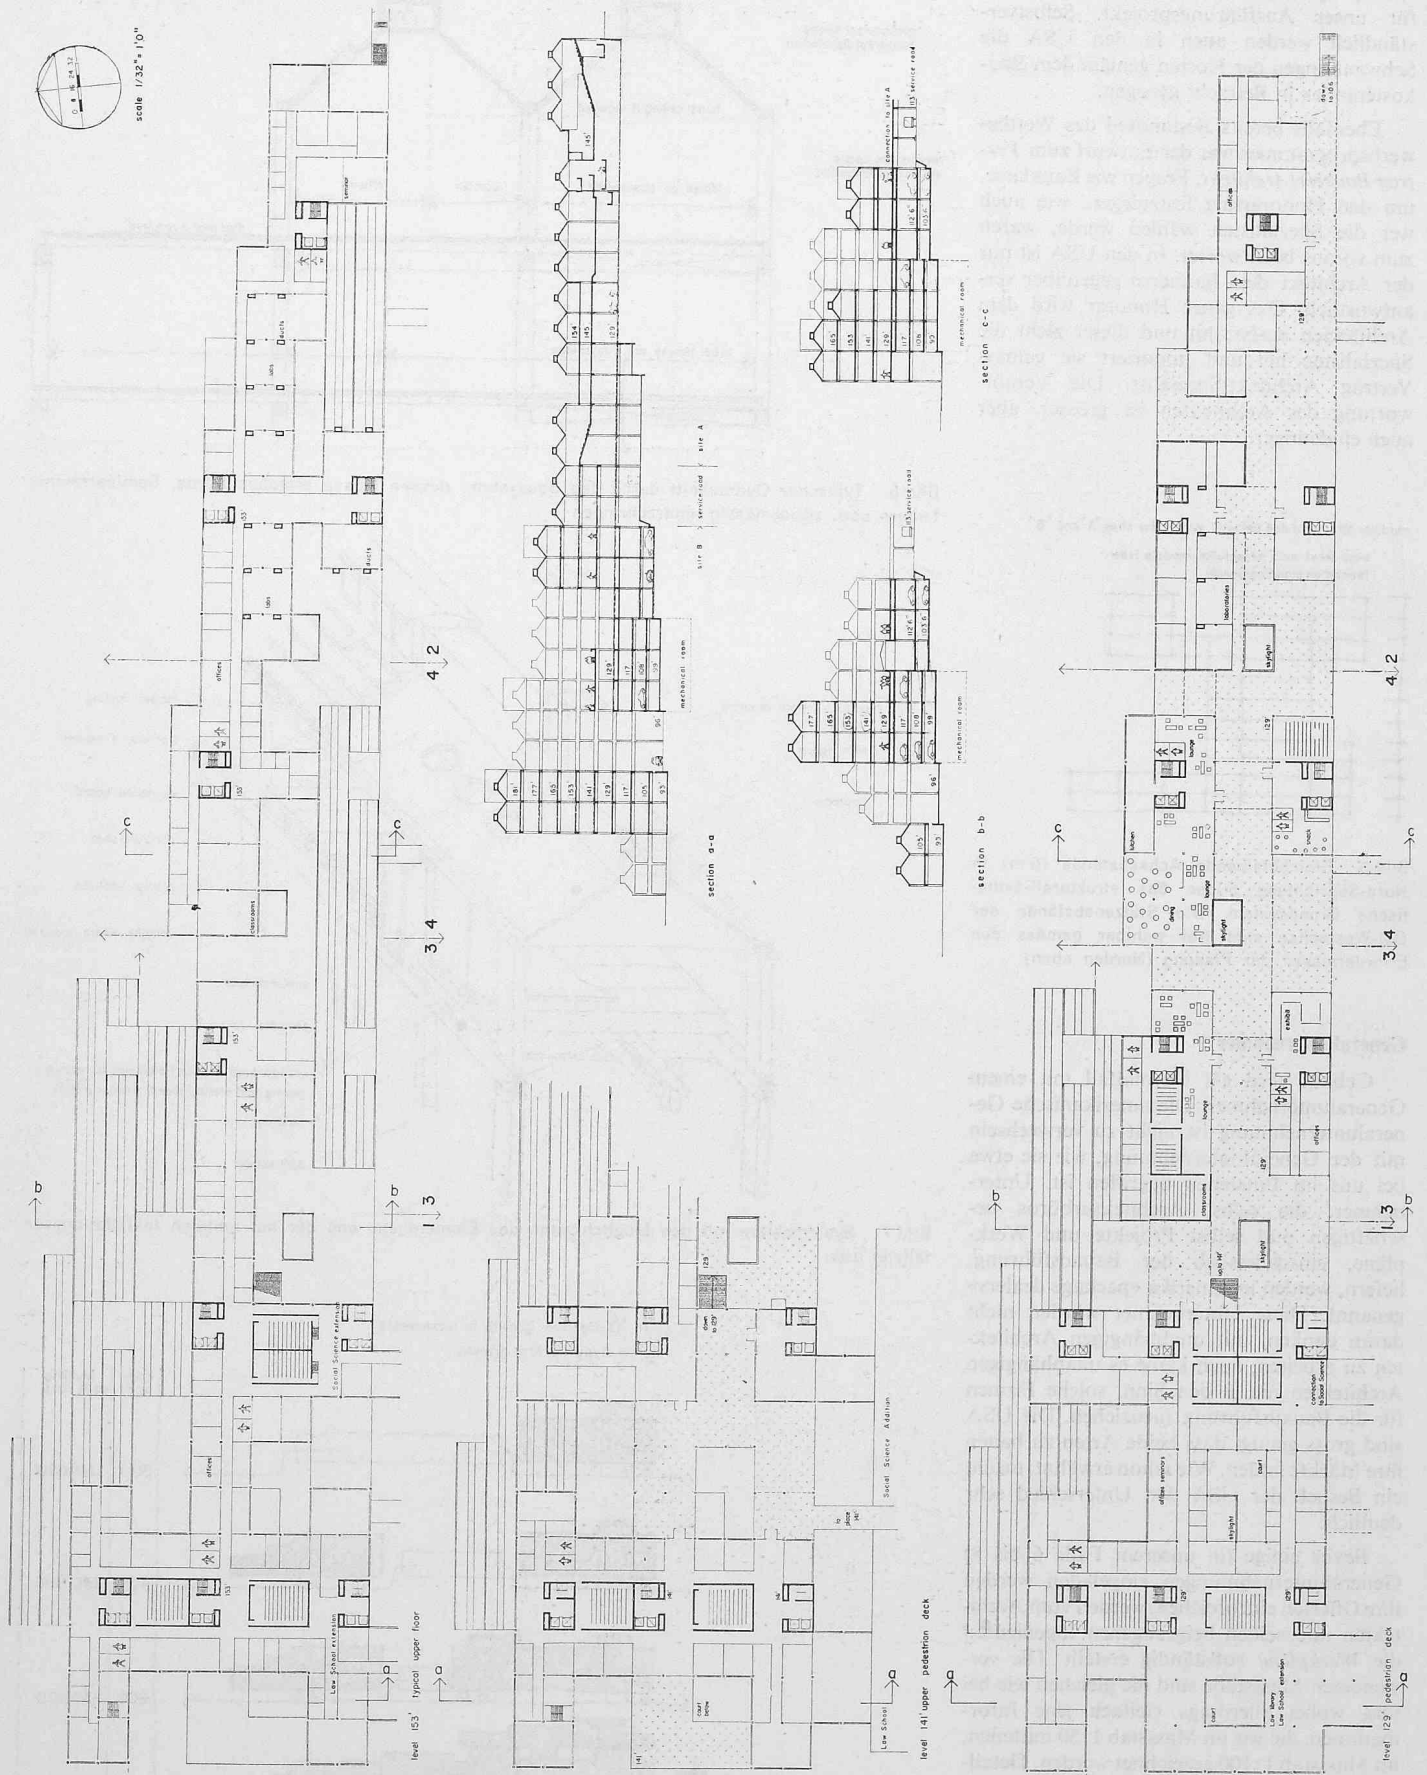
Erweiterungsprojekt. Grundrisse (Längsrichtung von Osten nach Westen). Oben: typisches Obergeschoss mit Hörsälen, Unterrichtsräumen, Büros usw. Mitte: Ausschnitt der oberen Fussgängerebene (level 141'). Unten: Hauptfussgängerebene (level 129'). Punktirt: überdeckte Verkehrsfläche
